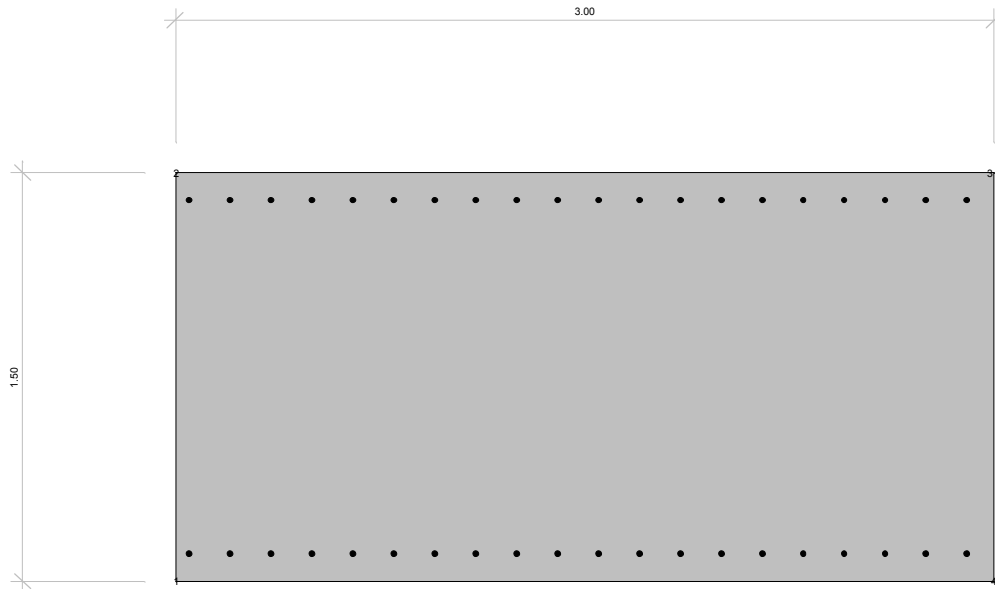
Platea di fondazione sotto al risvolto destro – Schematizzazione a elementi frame.
